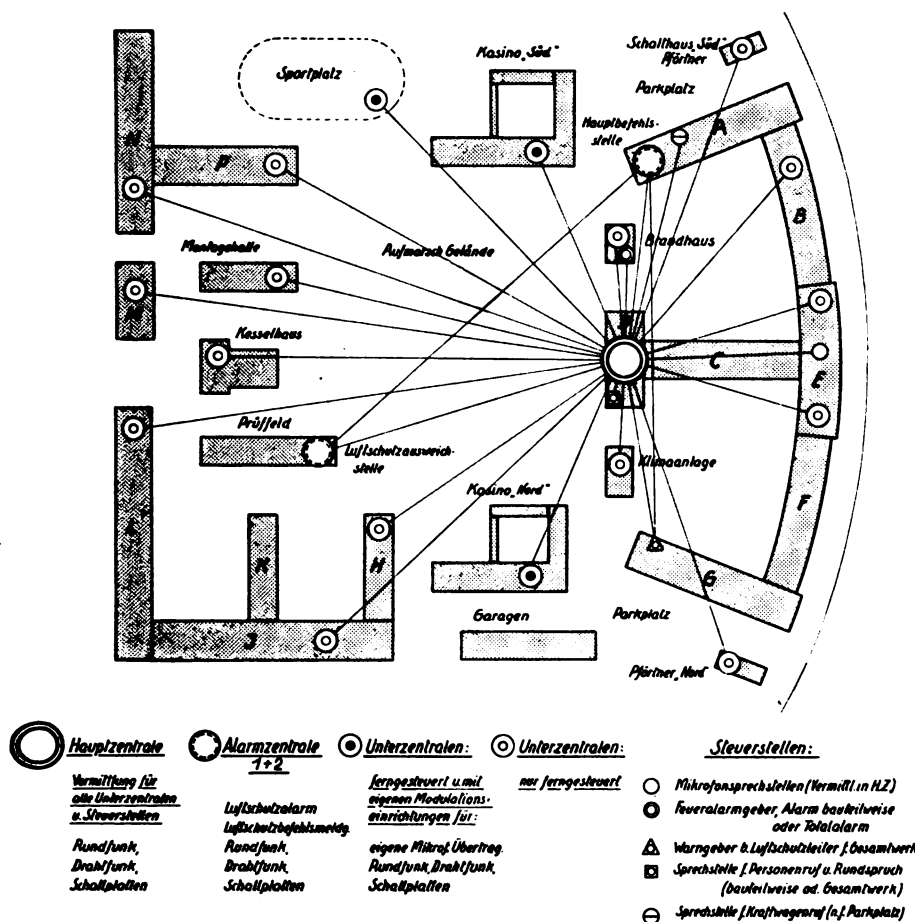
Gebäudeplan und örtlicher Aufbau der Betriebs-Lautsprecheranlage eines Großbetriebes.
